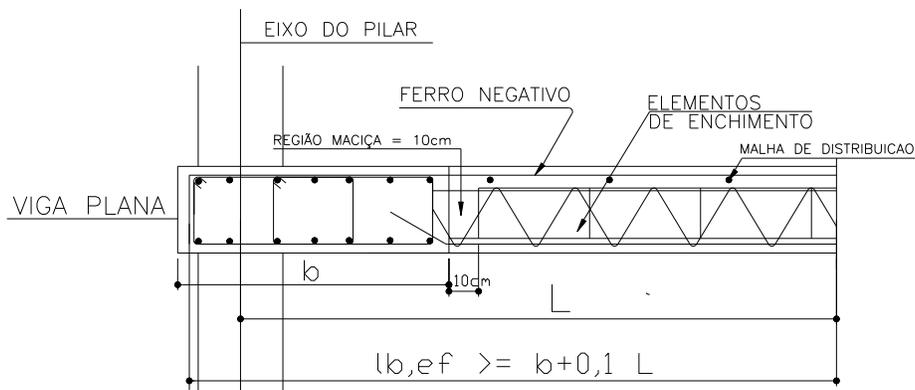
Detalhe de ancoragem das vigotas em viga plana ou capitel.
